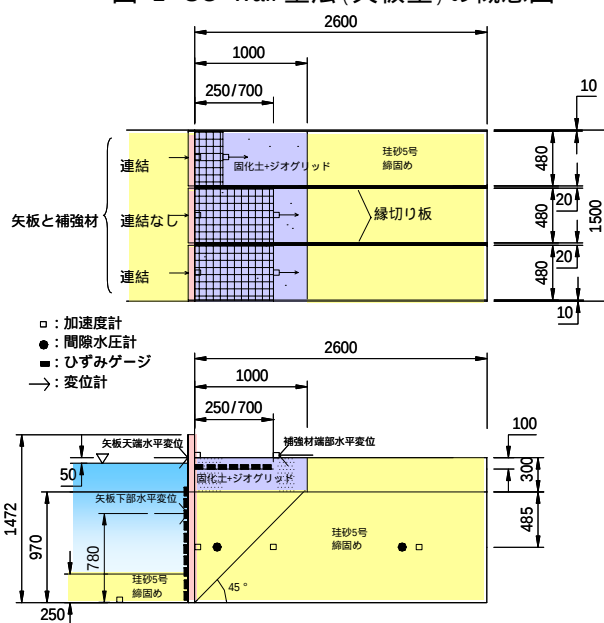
模型地盤平面図・断面図(Case-1.0 シリーズ)
